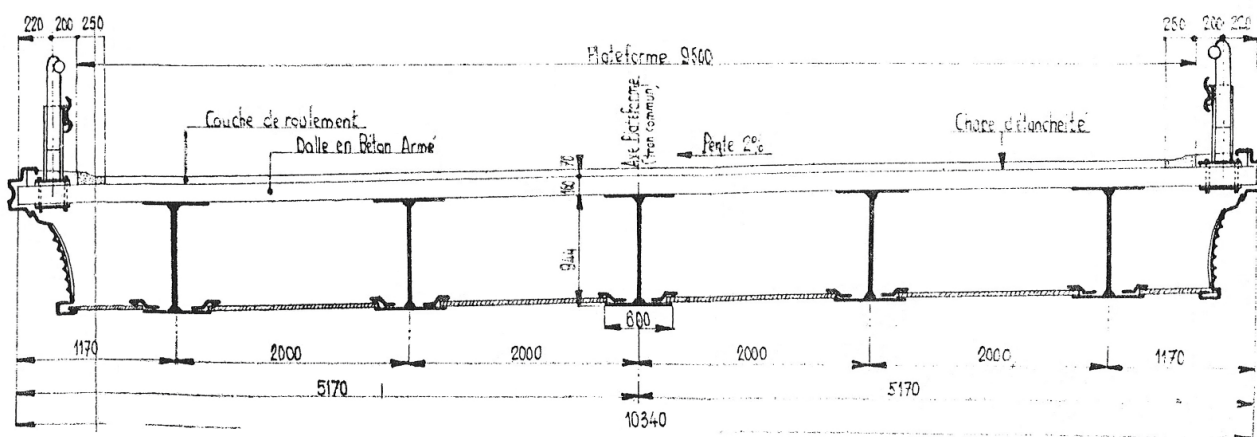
Extrait DOE – Coupe transversale de l'ouvrage
